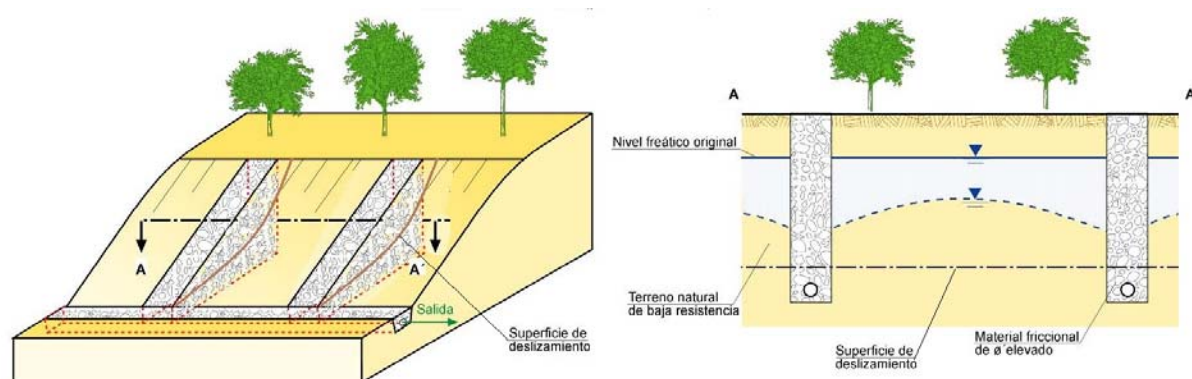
Combinación de drenaje y refuerzo. Zanjas contrafuerte
